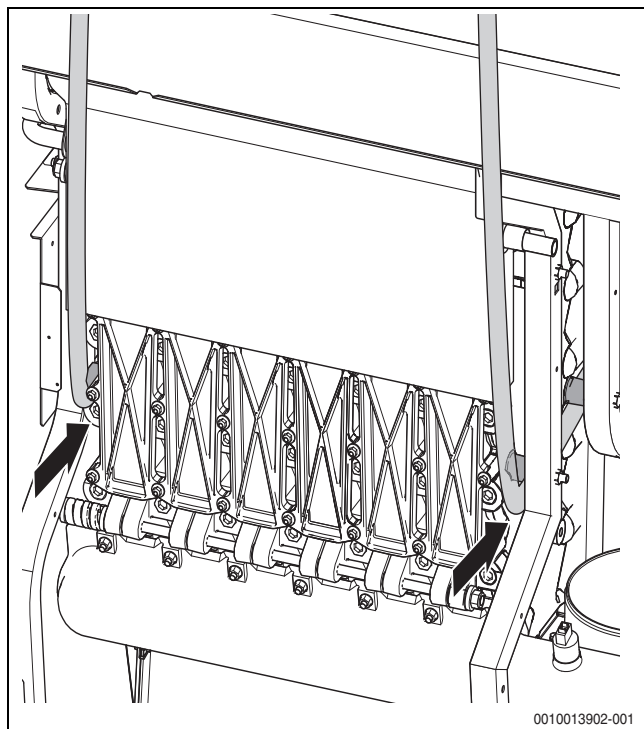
Inserção do equipamento de elevação da grua na estrutura
